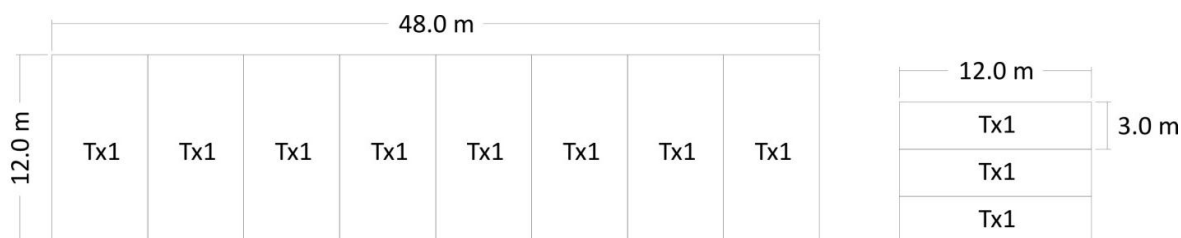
Archétype 3, plan d'étage (gauche) et élévation (droite)
